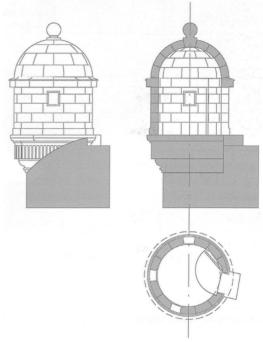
Alzado, planta y sección de la garita (Balaguer 2013)
